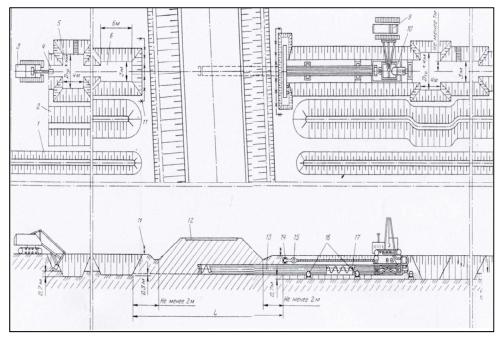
Технологическая схема прокладки кожуха методом ГНБ на переходе трубопровода под дорогой
